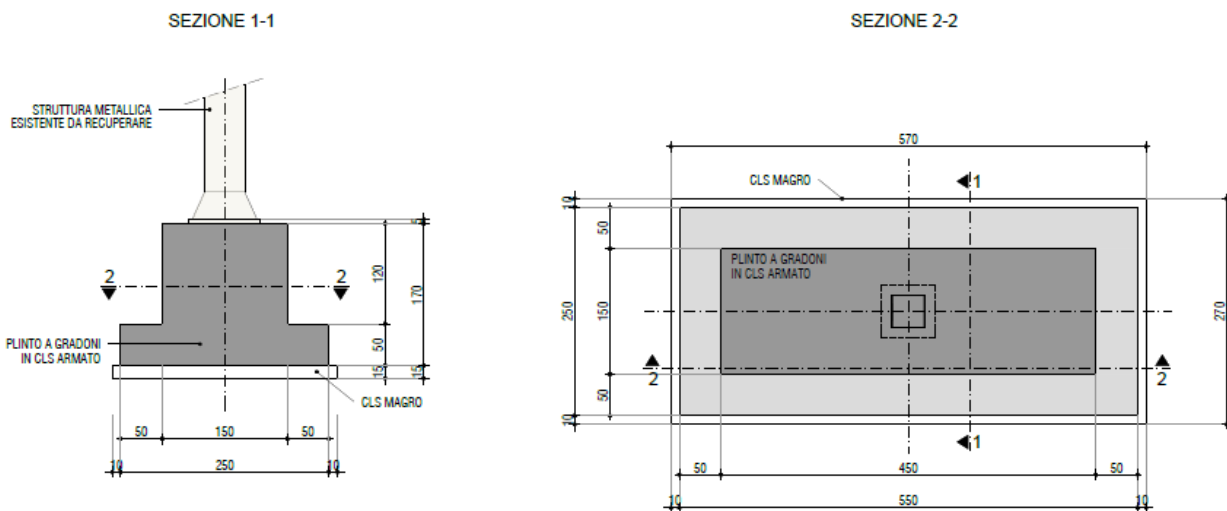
SEGNALE TIPO 3 – PLINTO DI FONDAZIONE
